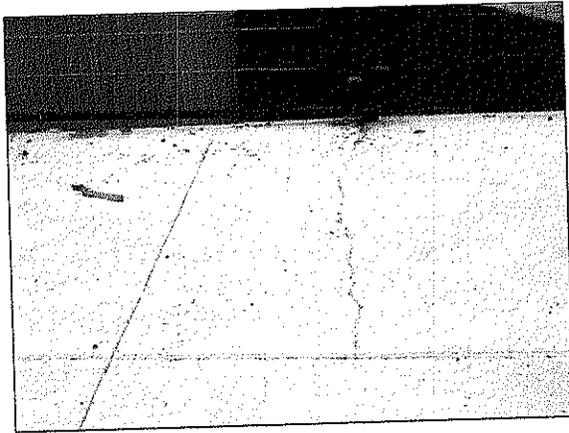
Presencia de grietas en aceras en Ruta 5, acceso norte a Temuco.
